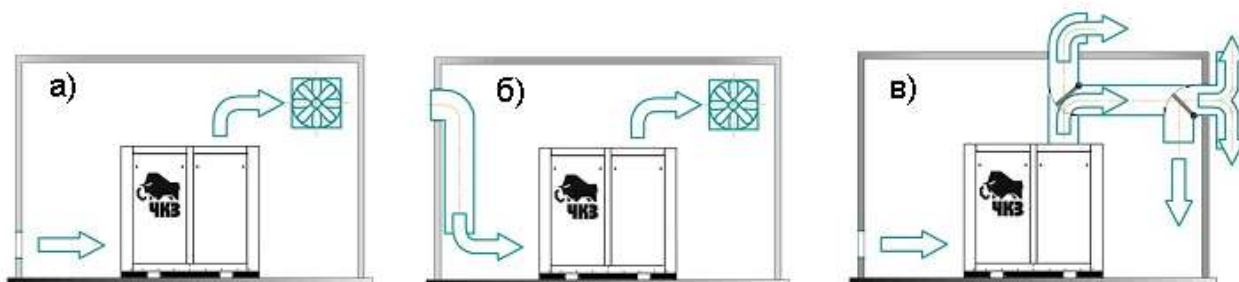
Варианты компрессорного помещения с искусственной аэрацией воздуха: а) – с использованием вентилятора; б) – с использованием вентиляционного короба и вентилятора; в) – с использованием воздуховода и системы заслонок.
